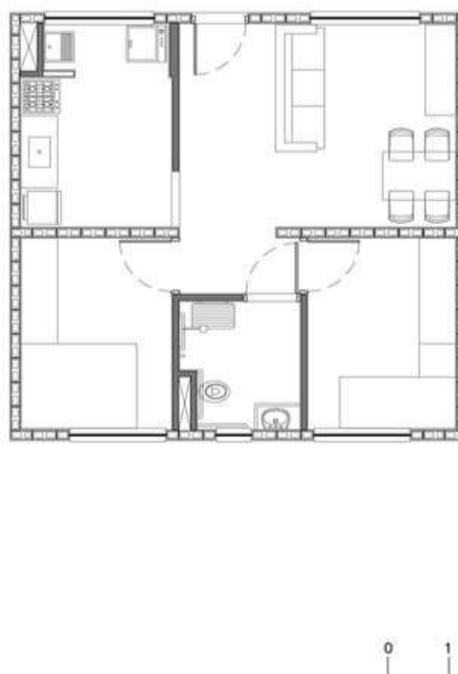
Casas Sobrepostas - Pavimento Tipo
